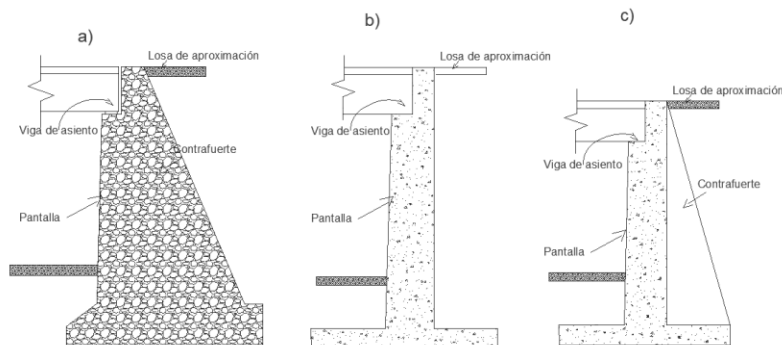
4 a) Estribo a gravedad, b) Estribo en voladizo, c) Estribo con contrafuerte
